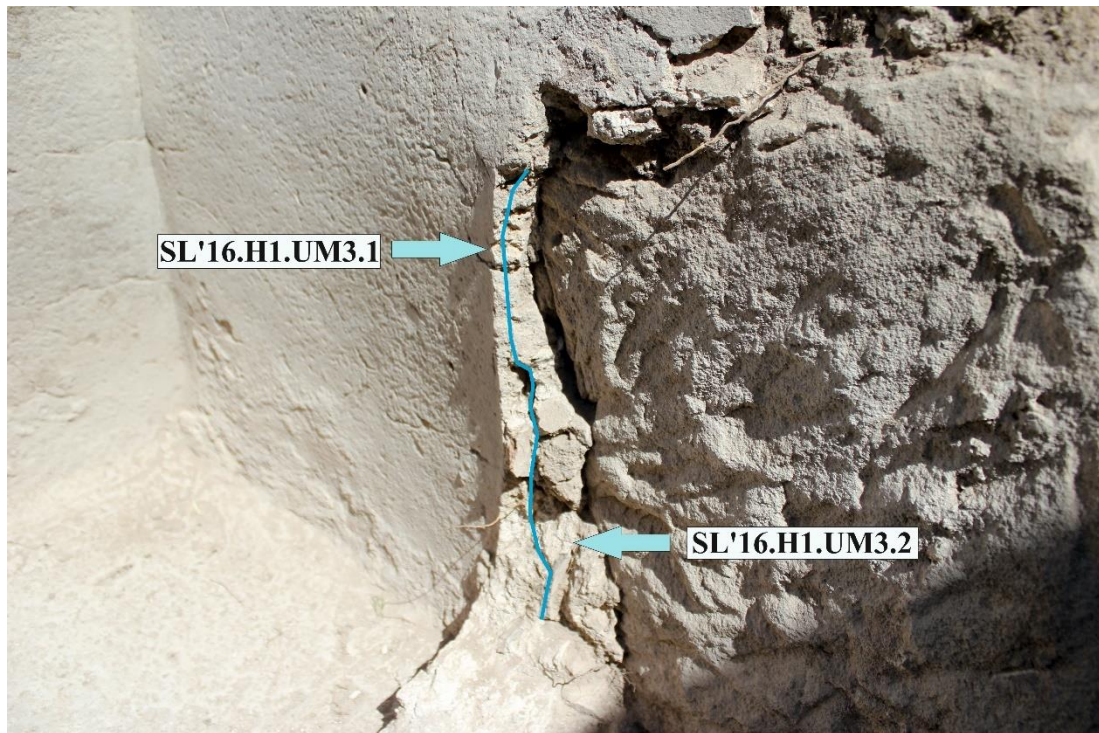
Detalle de la estructura D115 con las dos capas de morteros de donde se extrajeron las muestras SL16.H1.UM3.1 y SL16.H1.UM3.2.
